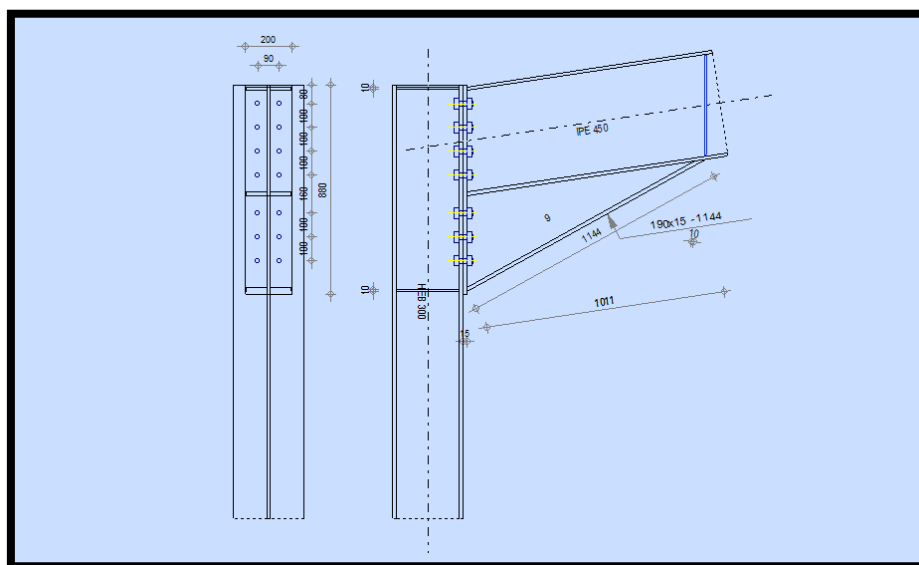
Disposition des boulons de l'assemblage poteau traverse.
